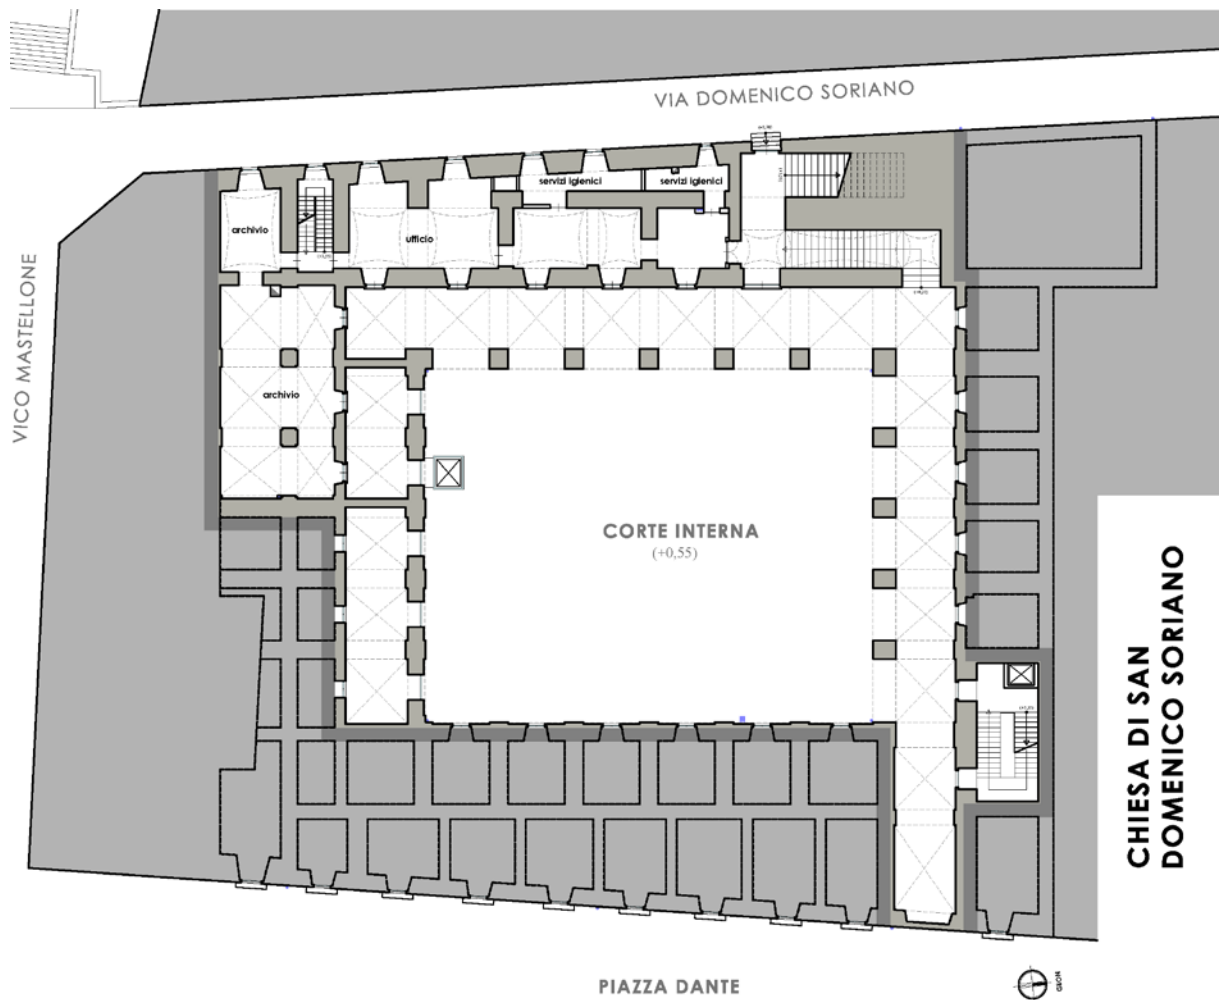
Indicazioni progettuali: Pianta Piano Terra - Ammezzato
